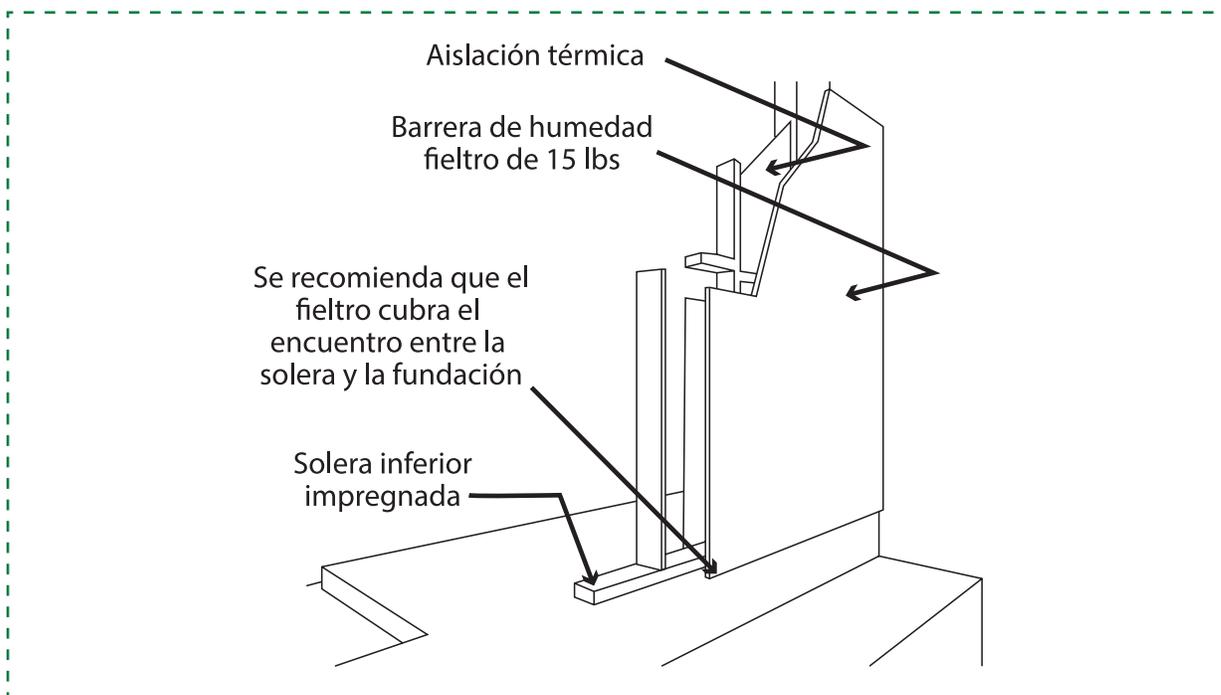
Revestimiento de tablero de contrachapado estructural, construcción de viviendas en madera
